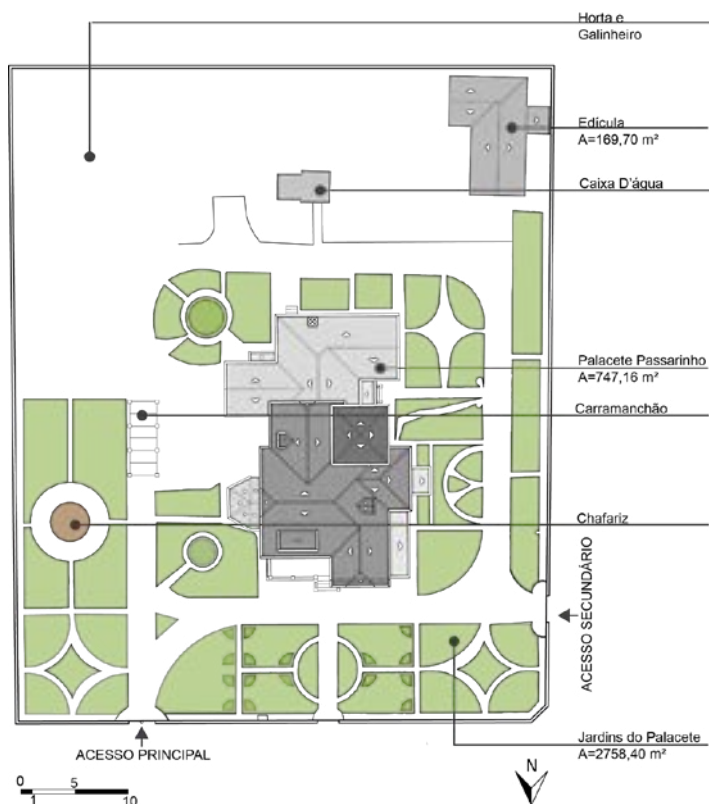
Reprodução da implantação do palacete e do traçado do jardim. Fonte: desenho de José Maria Morgado Neto, modificado por Pietra P. Barreto.
